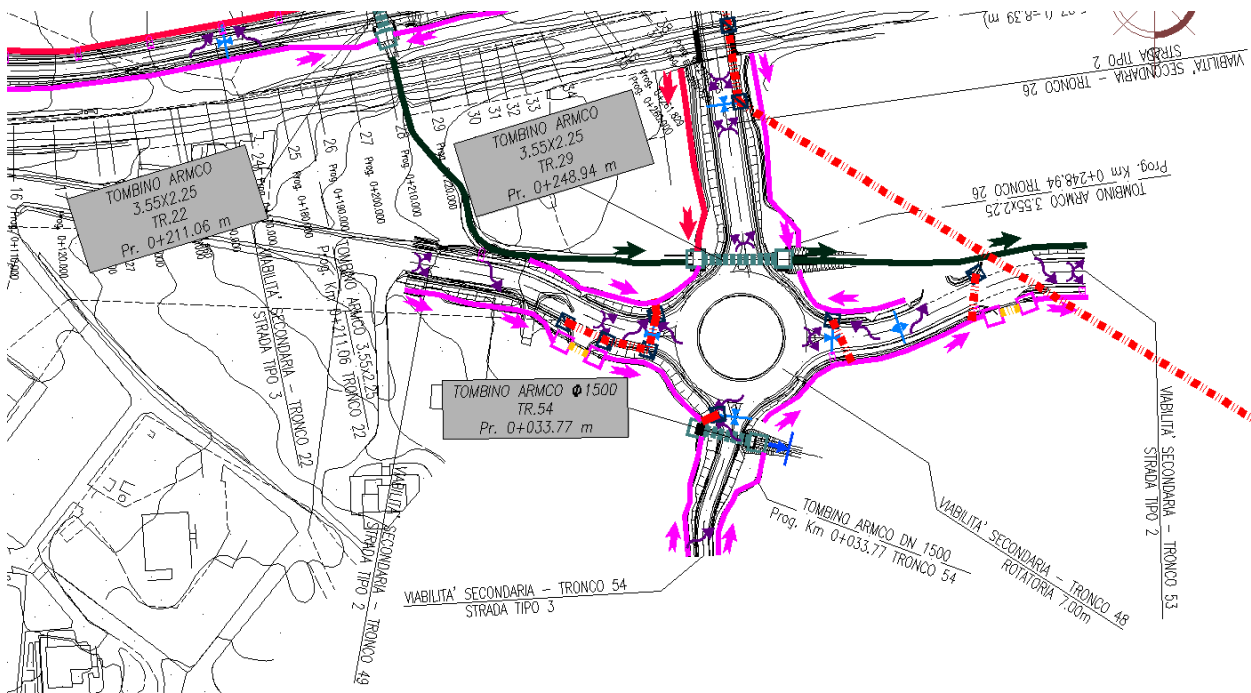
Stralcio planimetrico da Progetto Esecutivo
